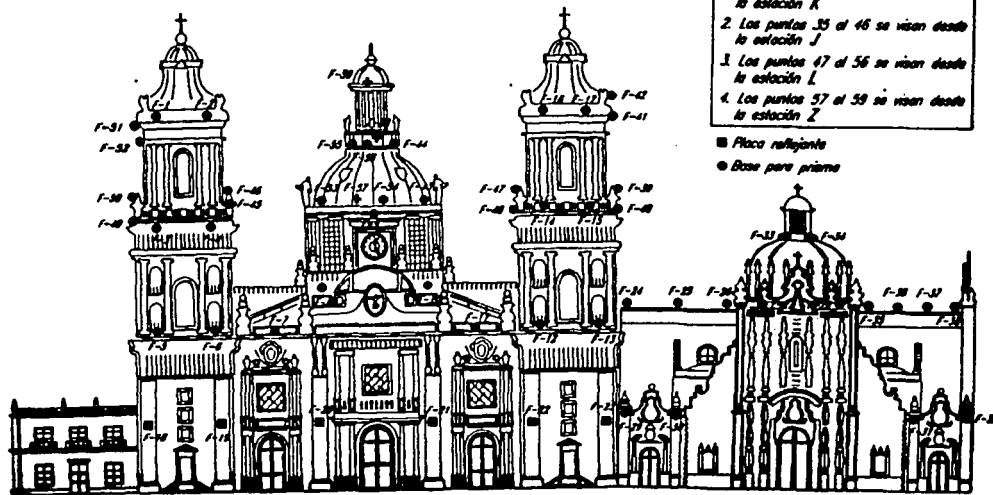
Puntos de control instalados en la fachada sur y cúpulas.
